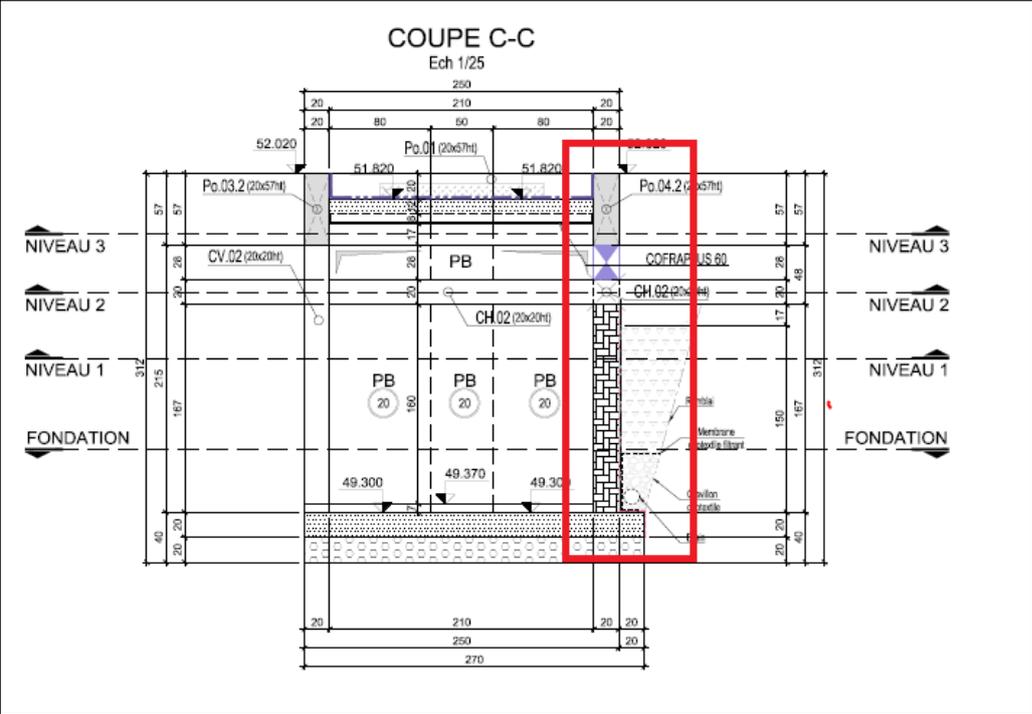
EXTRAIT PLAN DE COFFRAGE (COUPE).
